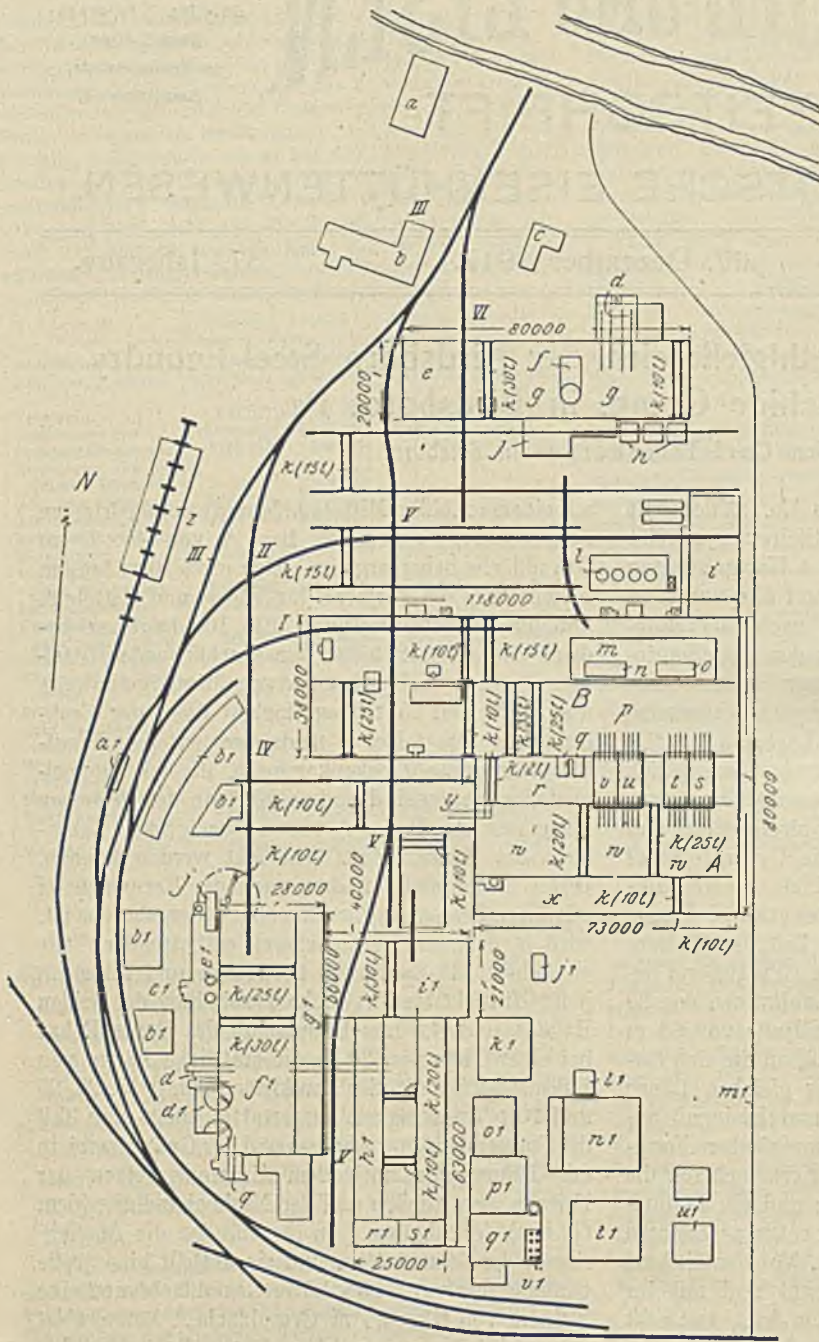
Lageplan der Gießerei der Birdsboro Steel Foundry and Machine Co. in Birdsboro, Pa.
